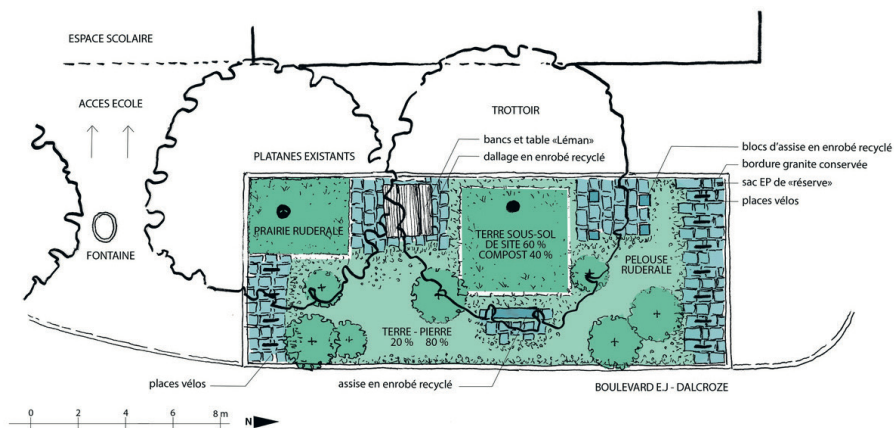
Plan Renaturation pieds d'arbres. source dessin: P. Heyraud/E. Amos & B. Goyard
